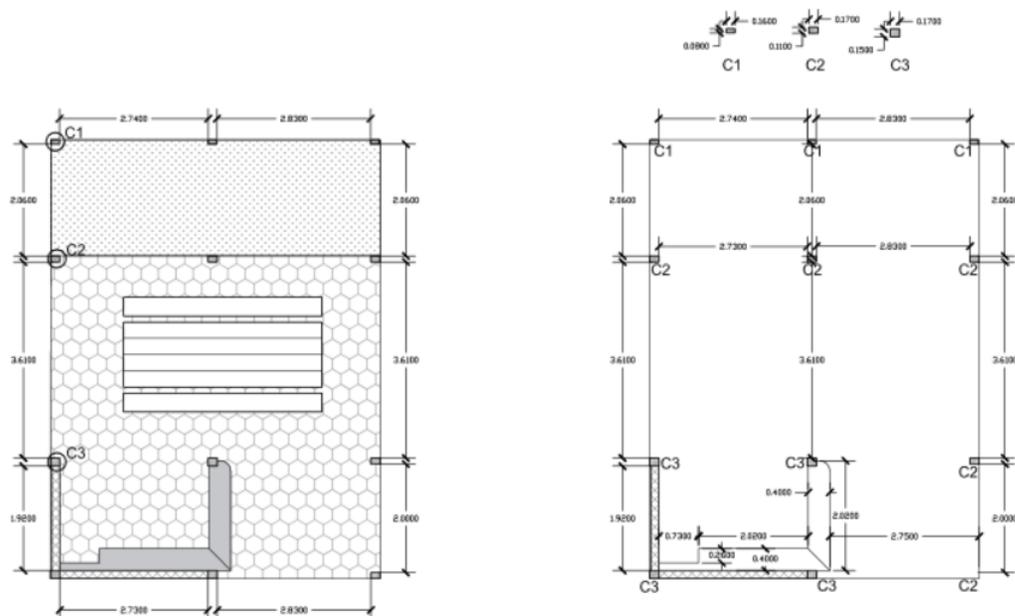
Instalación de baldosas de cerámica en fachada frontal
